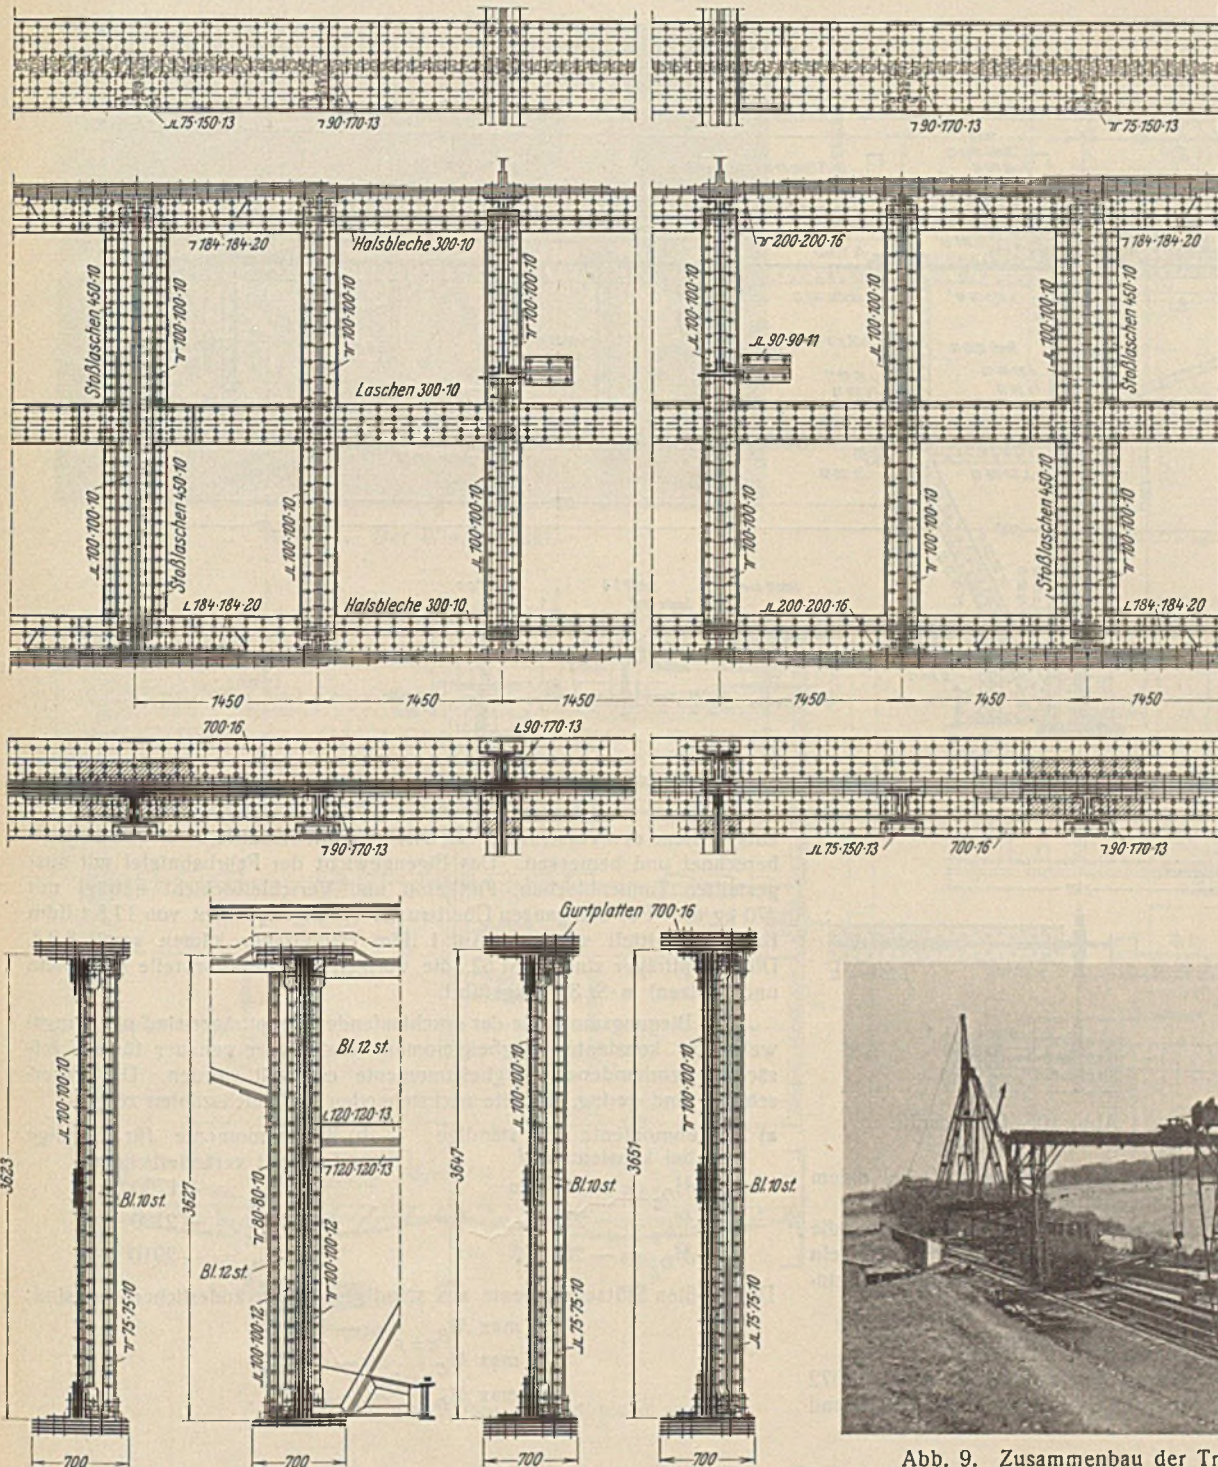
Hauptträger in der Mittelöffnung mit Universalstoß.
